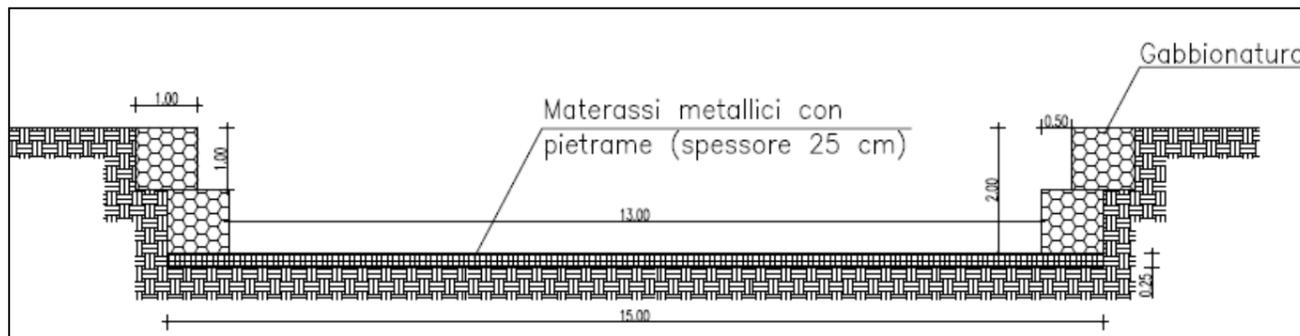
Sistemazione tipo Fosso Tor Tre teste
